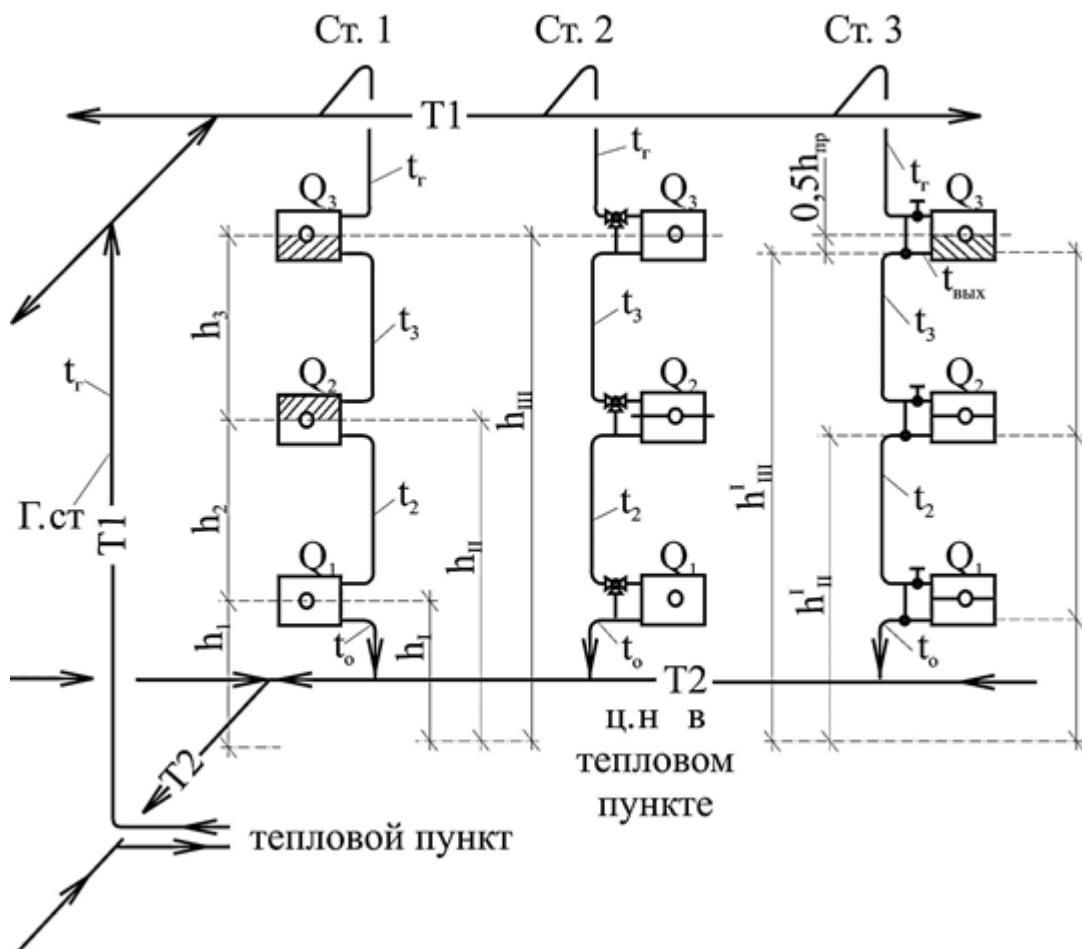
Расчетная схема вертикальной однотрубной системы водяного отопления с верхней разводкой:
